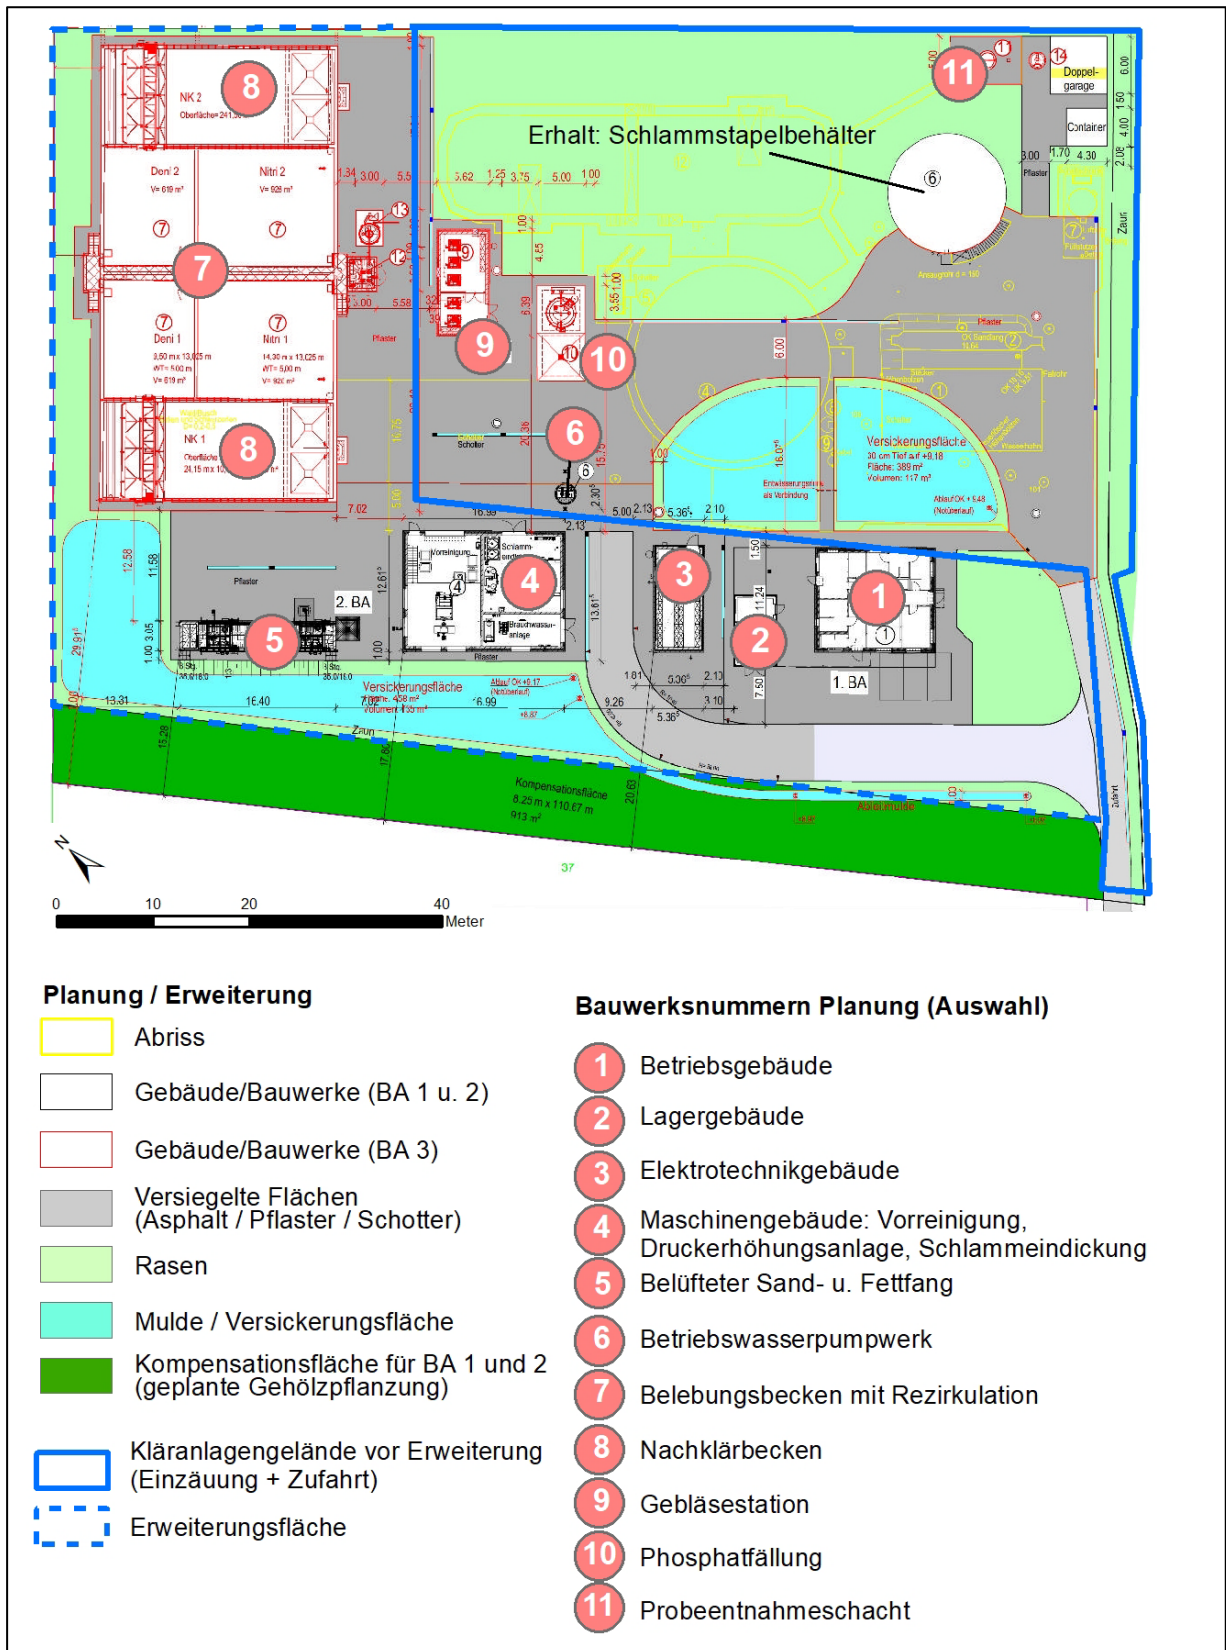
Geplante Erweiterung der Kläranlage (Auszug aus Lageplan, verändert)
